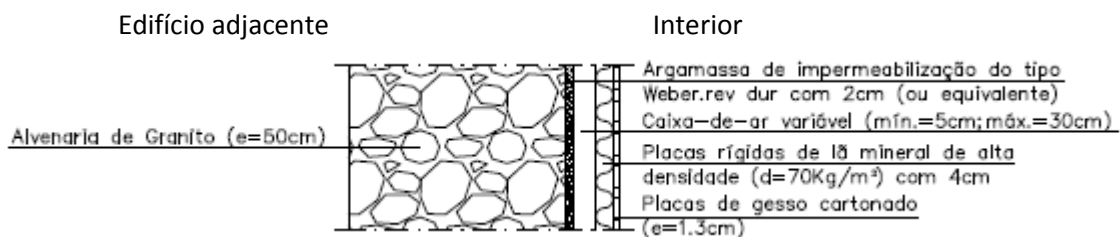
Pormenor construtivo da parede Pi6 [17]
